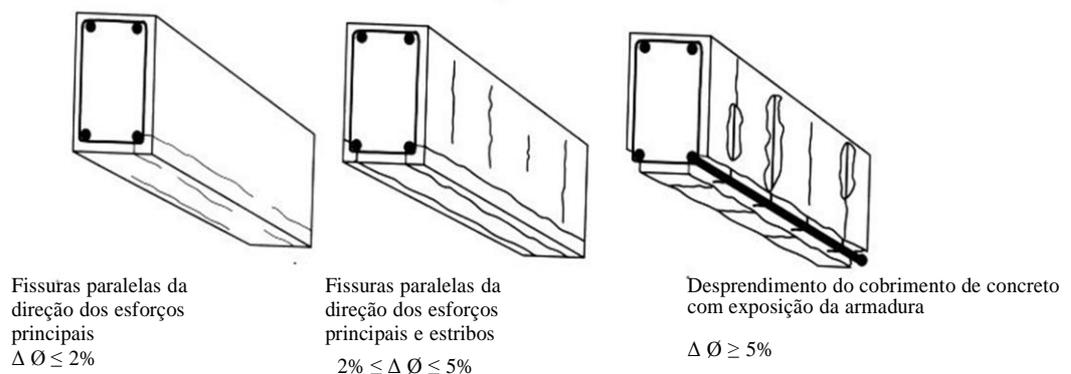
Representação esquemática das patologias tipicamente observadas em vigas de concreto afetadas por corrosão (HELENE, 2003).
